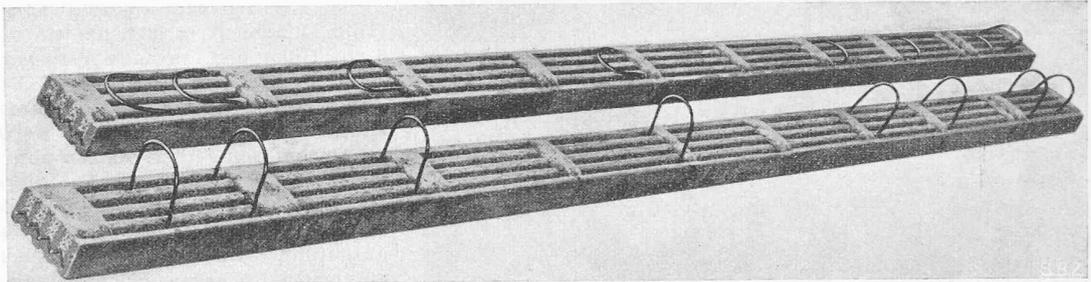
Vorgespannte Stahltonbretter 6/15 cm
